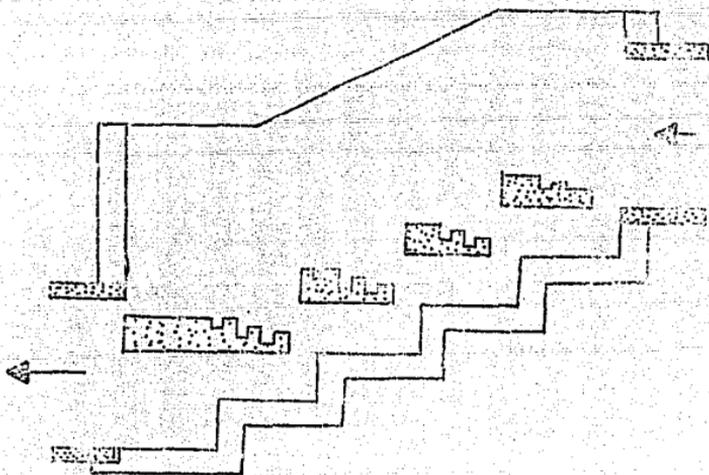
(c) Estructura de caída escalonada de 0.5 a 2.5 m para tuberías de 91 a 244 cm de diámetro.
